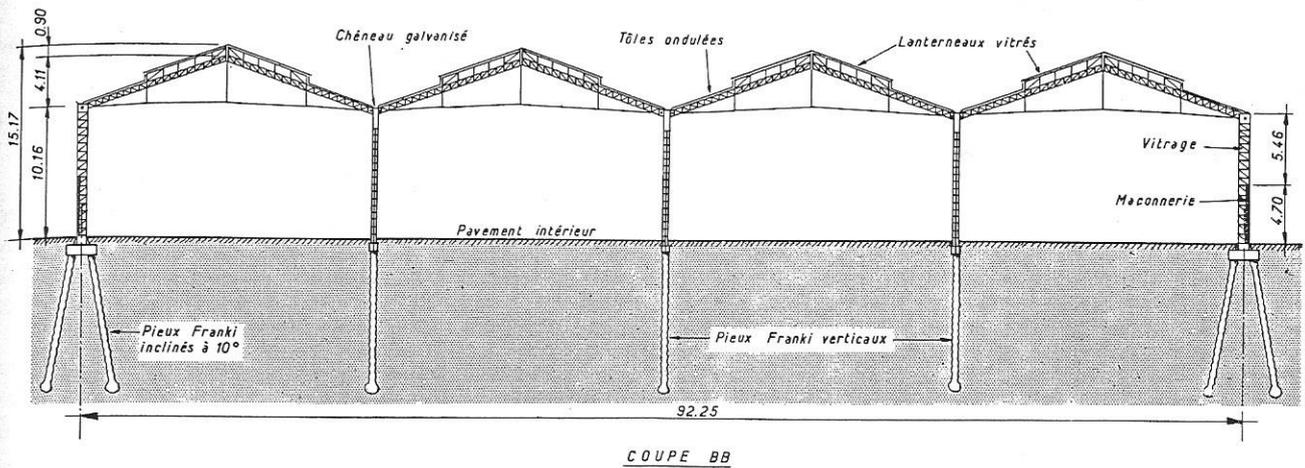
COUPE VERTICALE LONGITUDINALE, AU DROIT DES LANTERNEAUX. Cette coupe schématise, en particulier, le système de fondation adopté pour ce bâtiment qui repose sur un terrain formé de remblais récents et d'argiles diverses, très aquifères, sur près de 8 mètres de profondeur : 328 pieux en béton armé moulés dans le sol, système Franki, portant chacun 50 tonnes, dont 149 pieux inclinés à 10°, ceux-ci ayant pour but de résister aux efforts transversaux.
